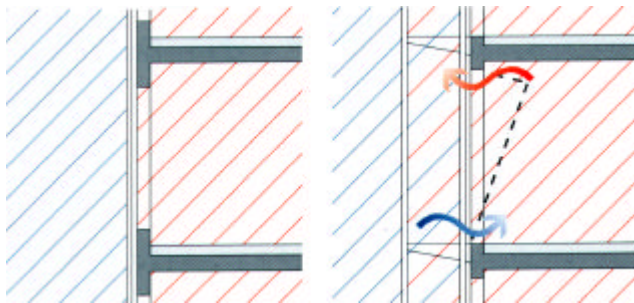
Nachtauskühlung mit hoher Sicherheit bei einer Zweite-Haut-Fassade, Quelle: Zweite-Haut-Fassade S. 5
